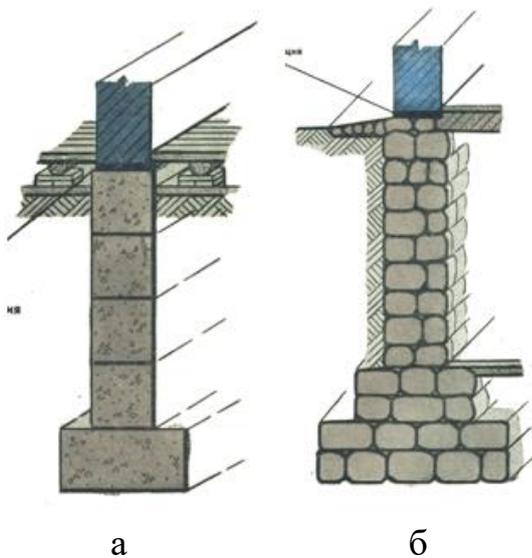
Стрічковий фундамент зі збірних блоків (а) та фундамент з бутової кладки (б)
